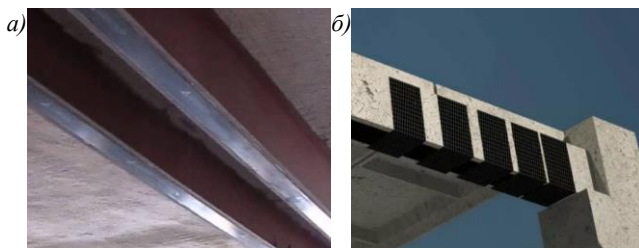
Усиление балки перекрытия углекомпозитом:
